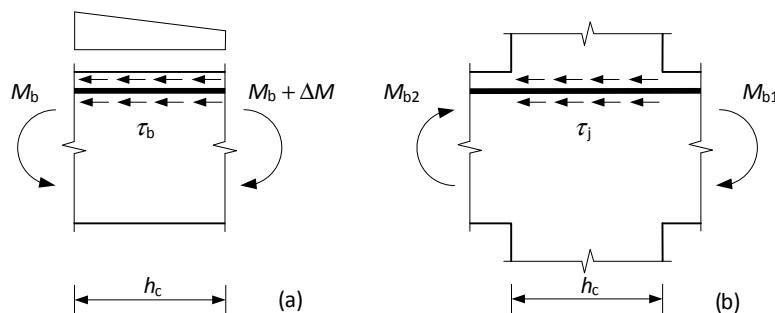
Tensão de aderência na armadura na interface armadura-betão: (a) segmento de viga com comprimento igual à altura da secção transversal do pilar, (b) ligação viga-pilar.
